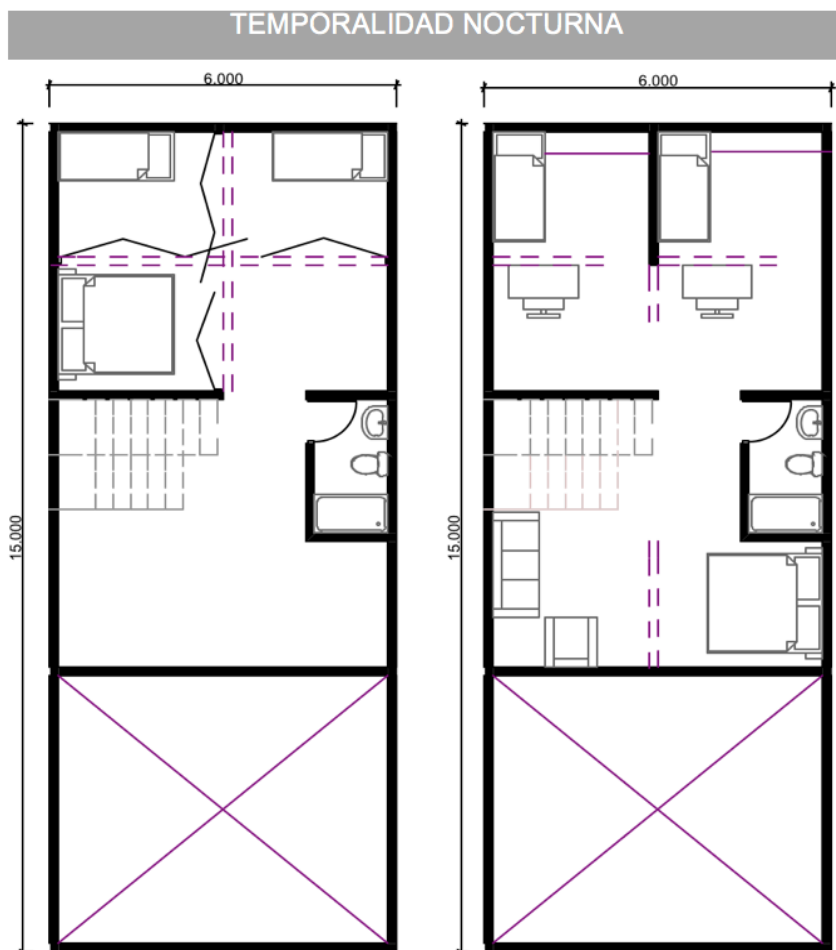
Planos arquitectónicos del modelo para familia de casados con dos hijos.
